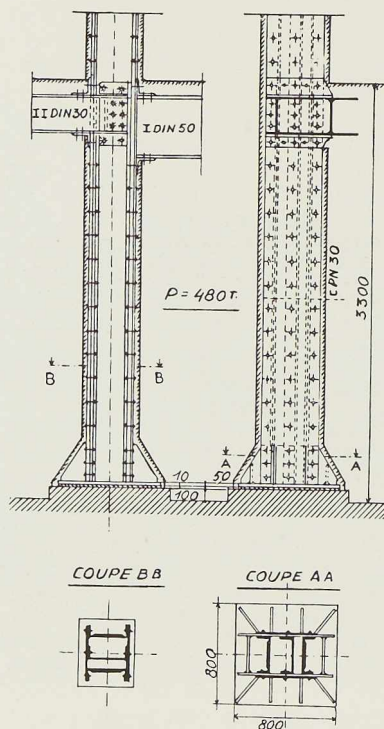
Bâtiment Jelmoli à Zurich. Elévations et coupes d'un poteau construit en rivure et supportant une charge de 480 tonnes.
